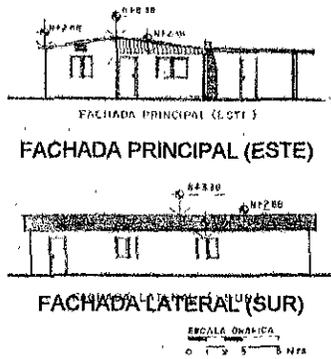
Fachadas principal (Este) y lateral (Sur), caso 11.
